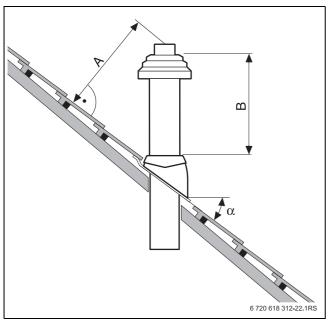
Abstandsmaße und Dachneigungen bei Schrägdach
